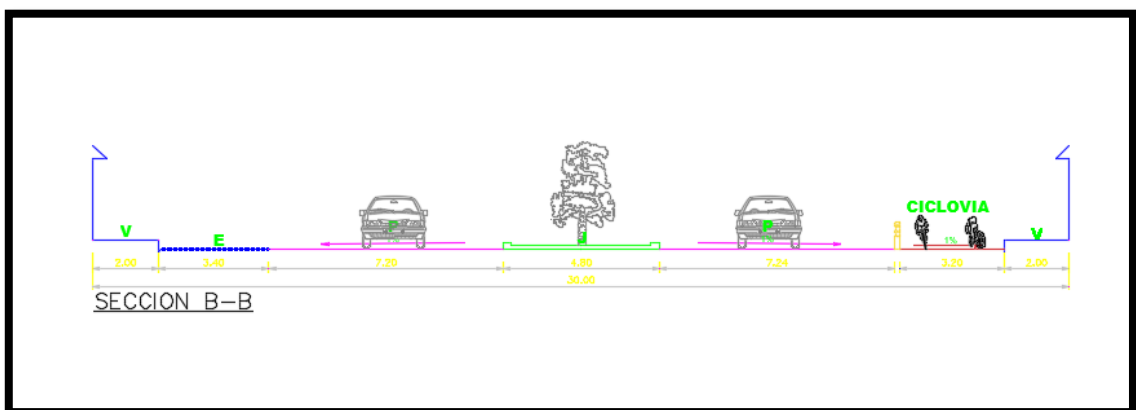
Corte Transversal de la Ciclovía, Sección B-B.
